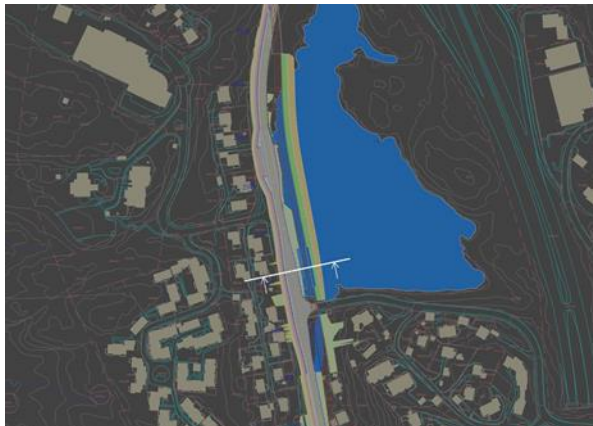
Snitt viser plassering av holdeplass øst for Griggastemma i KU-alternativet. Se plassering av snitt på plantegning over
